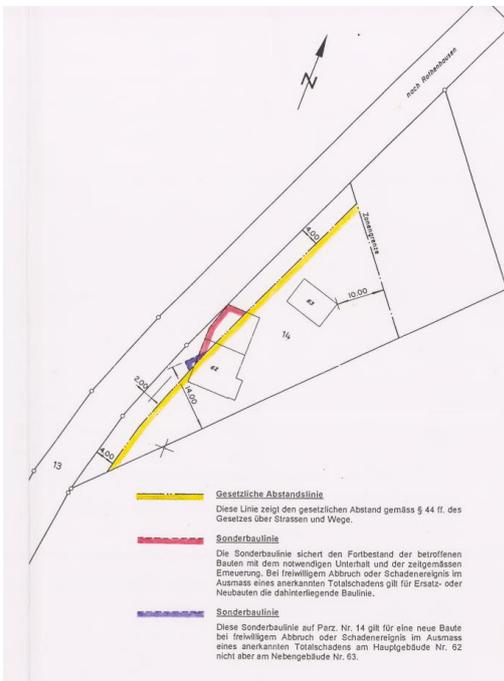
Planausschnitt BLP Teiländerung 1995
